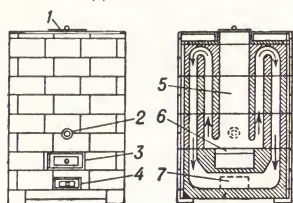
Печь длительного горения: 1 — загрузочное отверстие; 2 — глазок; 3 — зольник; 4 — отверстие для прочистки; 5 — камера (бункер) для топлива; 6 — колосниковая решётка; 7 — дымоход (сзади).
